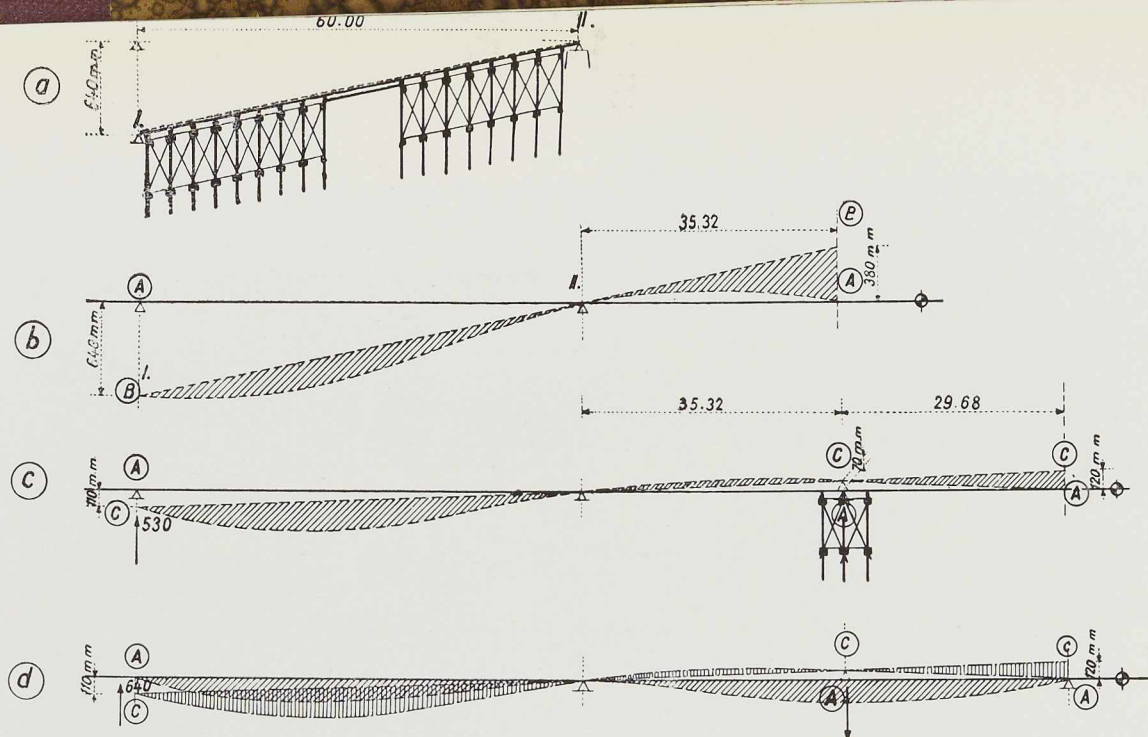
(ci-dessus). Schéma de montage du premier tronçon (voir p. 420).
